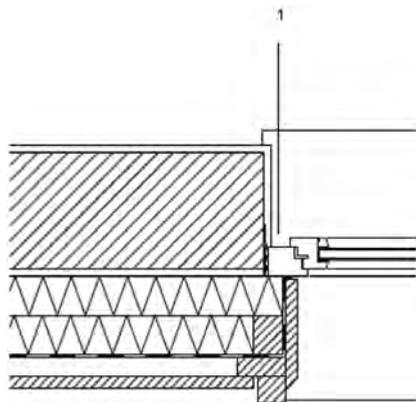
Стык окна с наружной стеной, защищенной навесной вентилируемой фасадной системой (горизонтальный разрез): 1 — наружные кромки окна заподлицо с кладкой
